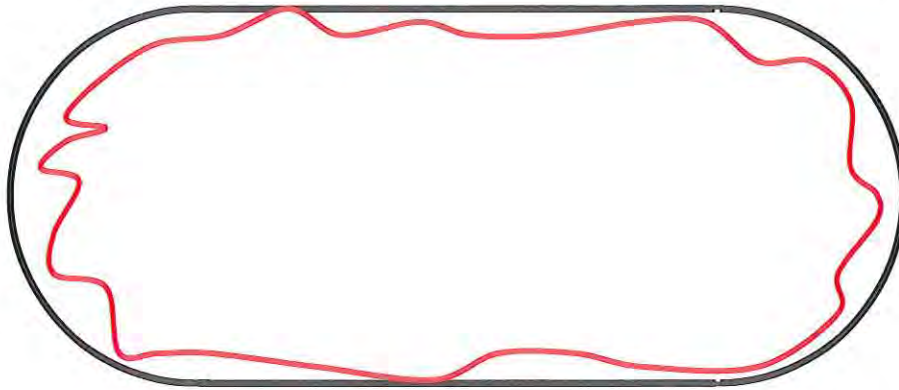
Schematischer Grundriss einer Kaverne: Für die Modellierung angenommene abdeckende Einhüllende (schwarz) und tatsächlich vorhandene Kavernenkontur (rot)
